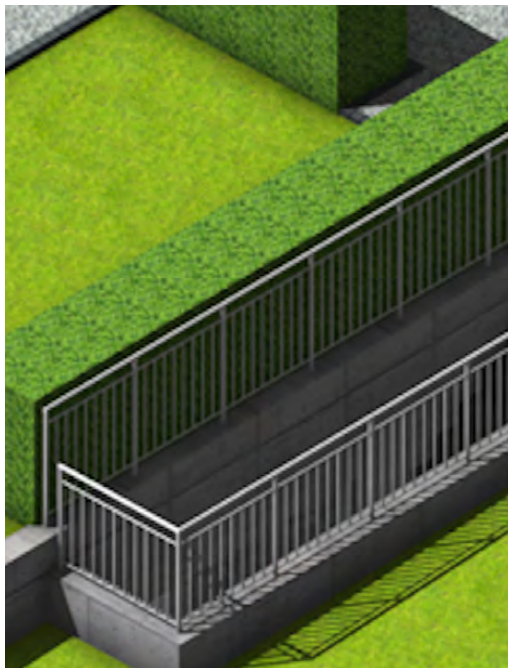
Abschränkung erstellt mit dem Werkzeug „Geländer“
